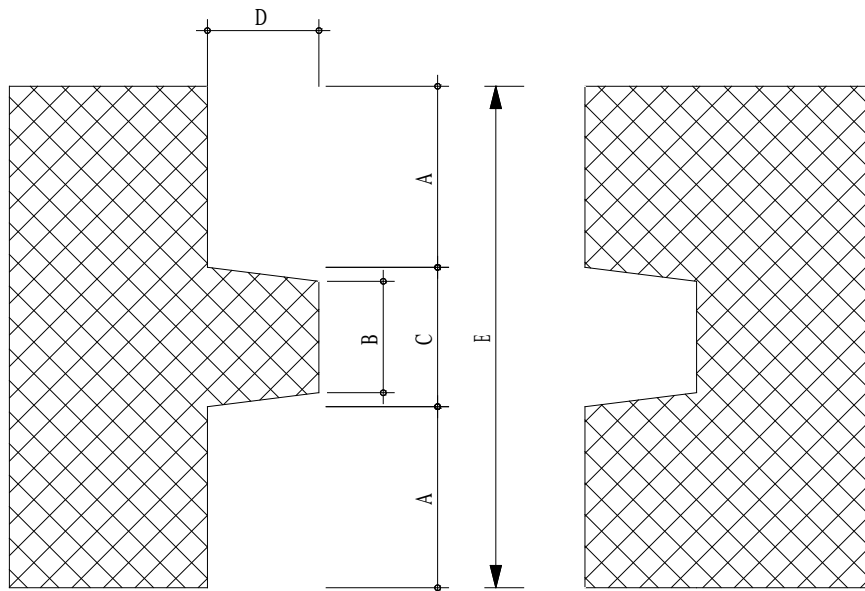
Détail de l'usinage des tranches des panneaux rainurés bouvetés (usinage optionnel)
